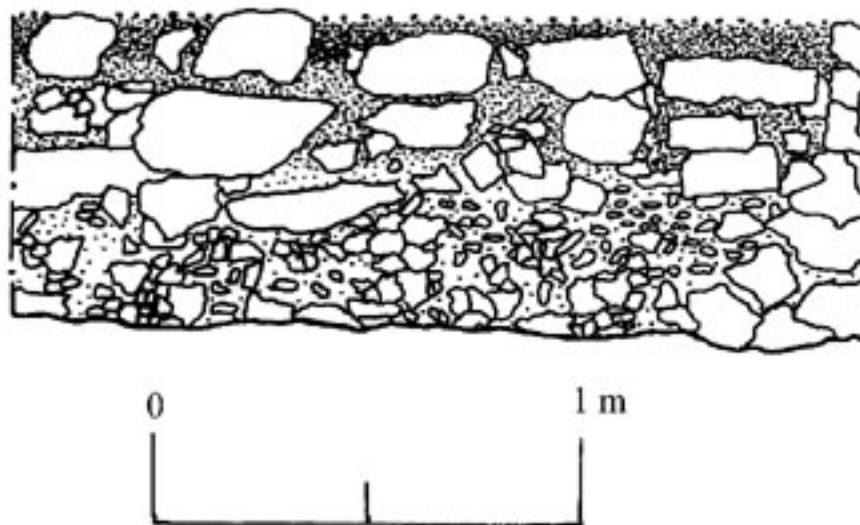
PN 53B-1-3 Vista frontal del muro en la Estructura Z-5.
